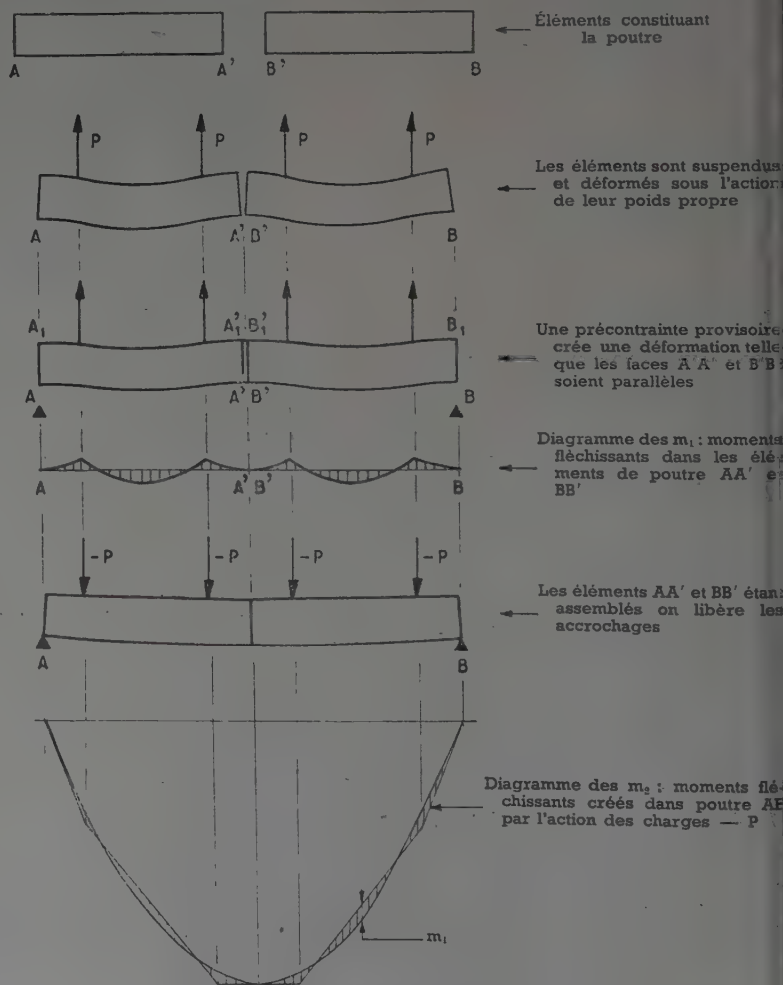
Schéma de la mise en place d'une poutre droite composée de deux éléments.
